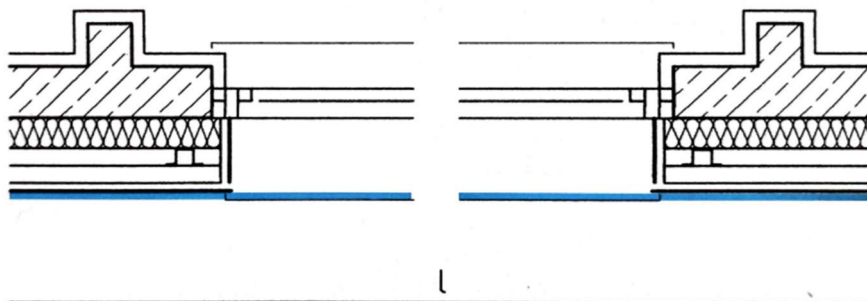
Bardage en panneaux stratifiés ; coupe horizontale sur façade $A = l * h$
